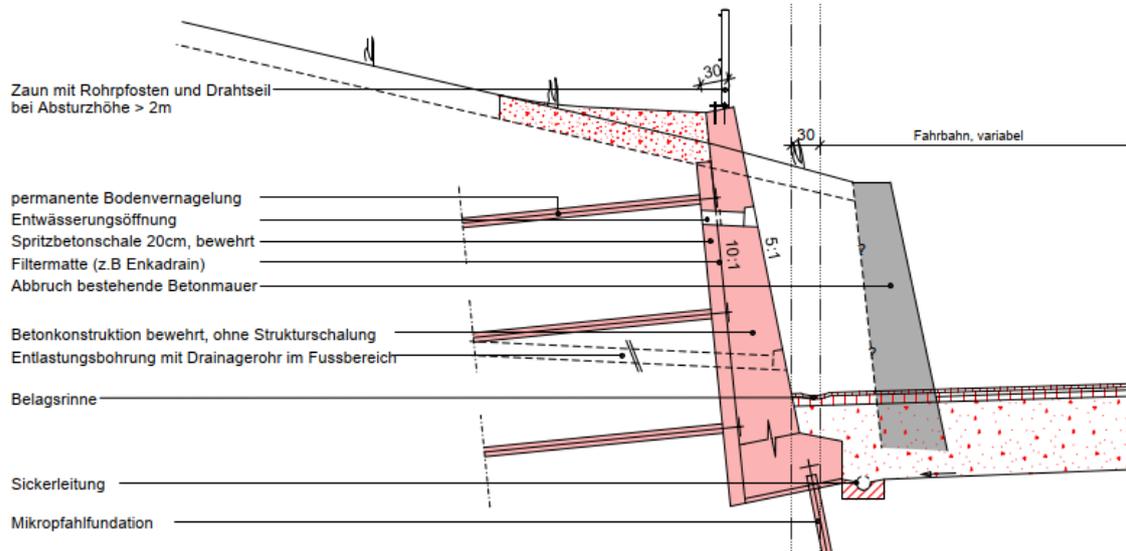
Normalprofil B 2 – Betonstützmauer mit Struktureinlage
